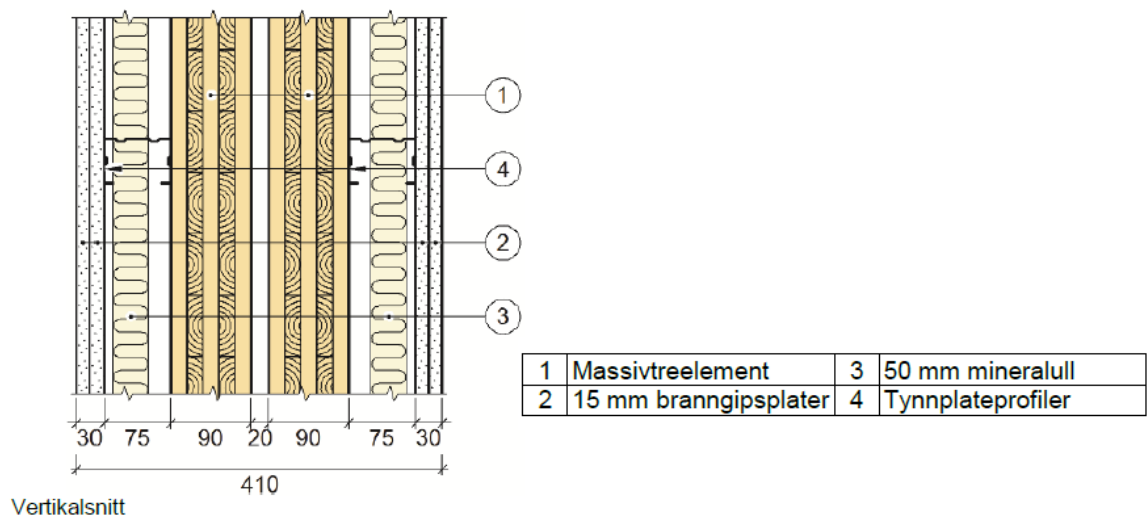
Branntesting av massivtre element. Elementet oppfyller REI 90 (79).
